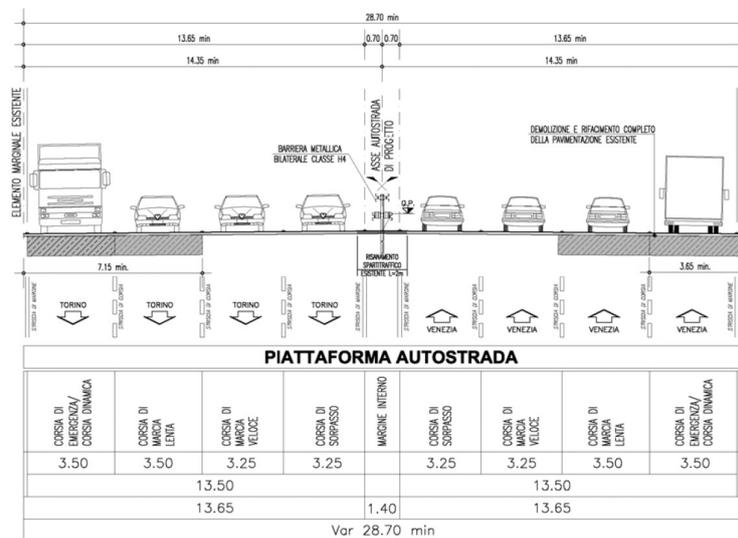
Sezione tipo del tratto di Autostrada A4 in progetto
